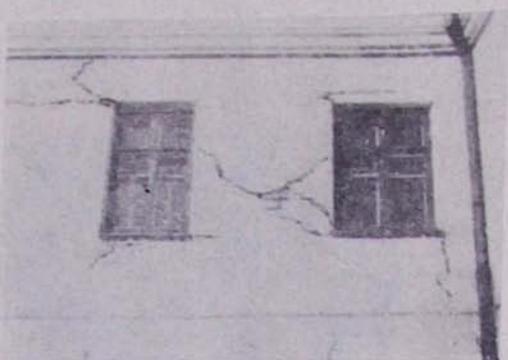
Повреждения наружной стены кирпичного 2-этажного жилого дома
